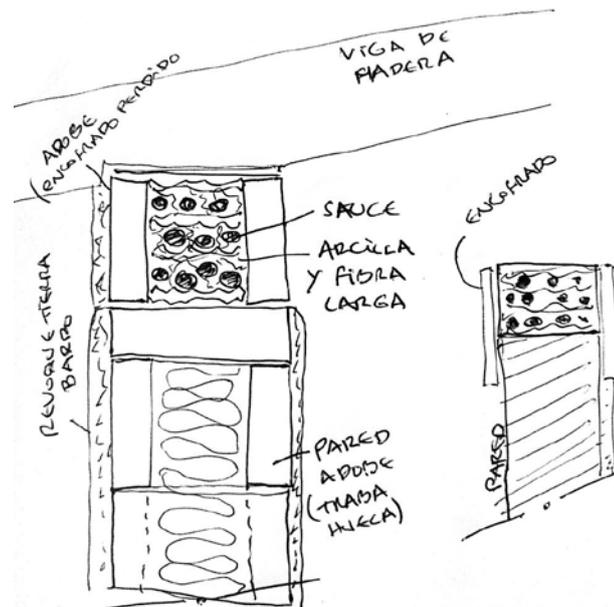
Detalle constructivo de la pared de adobe "traba hueca" con su encadenado de sauce y barro (crédito: M. Aresta)
